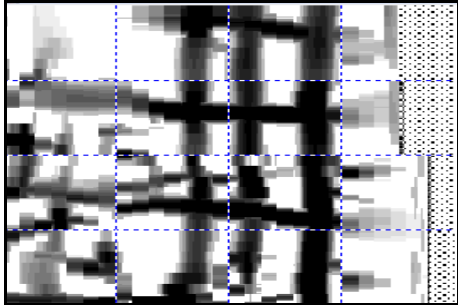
Imagen del detector de metales en la Viga B' (3'-4')
